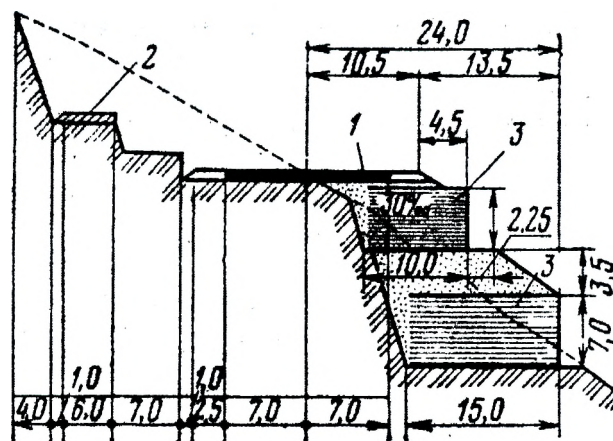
Поперечный профиль дороги на косогоре с двумя подпорными стенами из армированного грунта: 1 – основная дорога; 2 – вспомогательный путь для прохода дорожных машин во время строительства; 3 – подпорные стенки из армированного грунта
